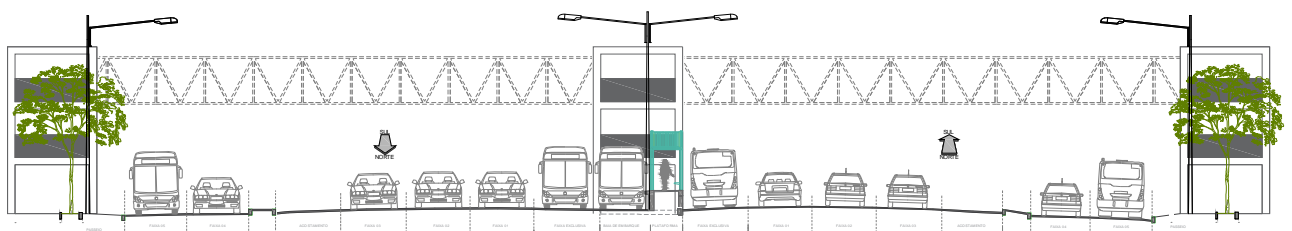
Corte AA – Desenho Proposta da BR 116 - Fonte: SEINF
